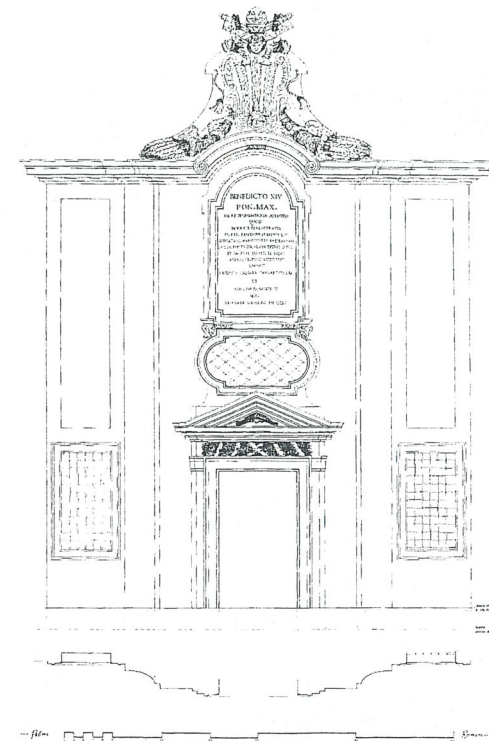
Prospetto e profilo orizzontale alla quota delle due finestre laterali (rilievo dell'autore, 1995).
